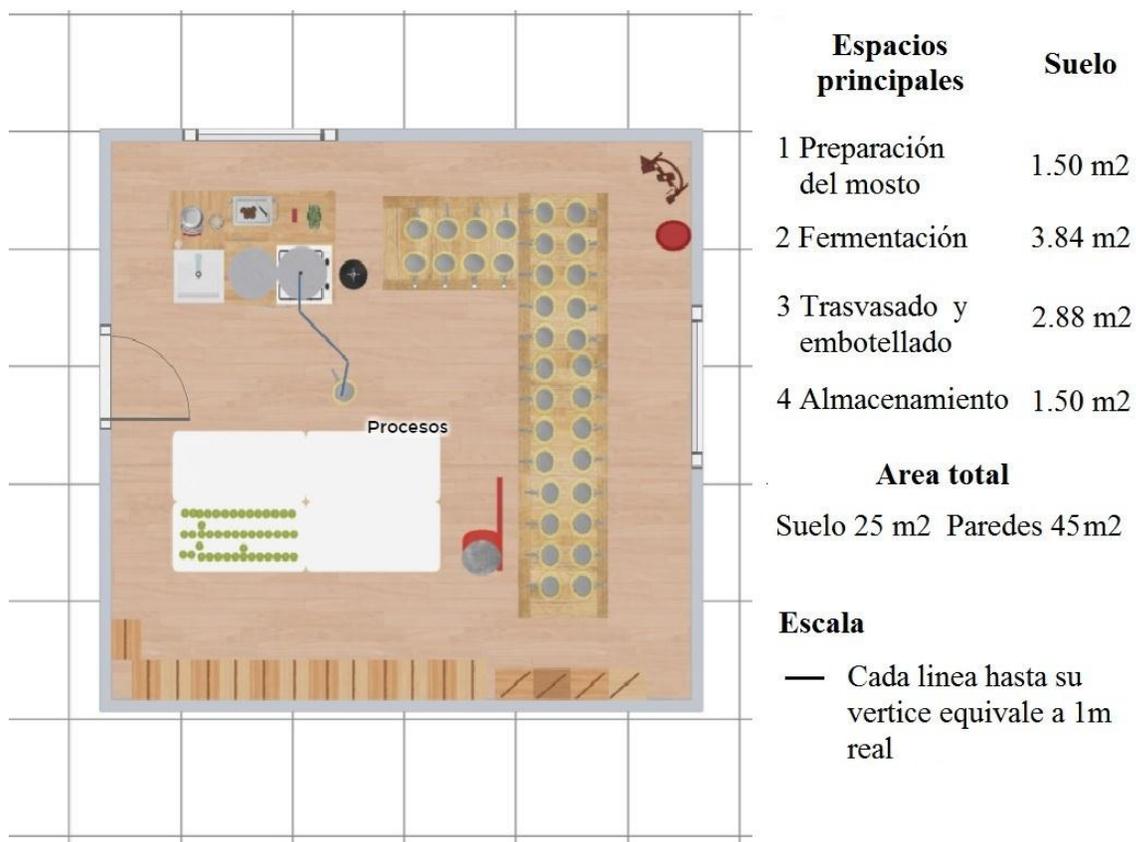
Plano de planta para la producción rústica de vino de miel de abeja
